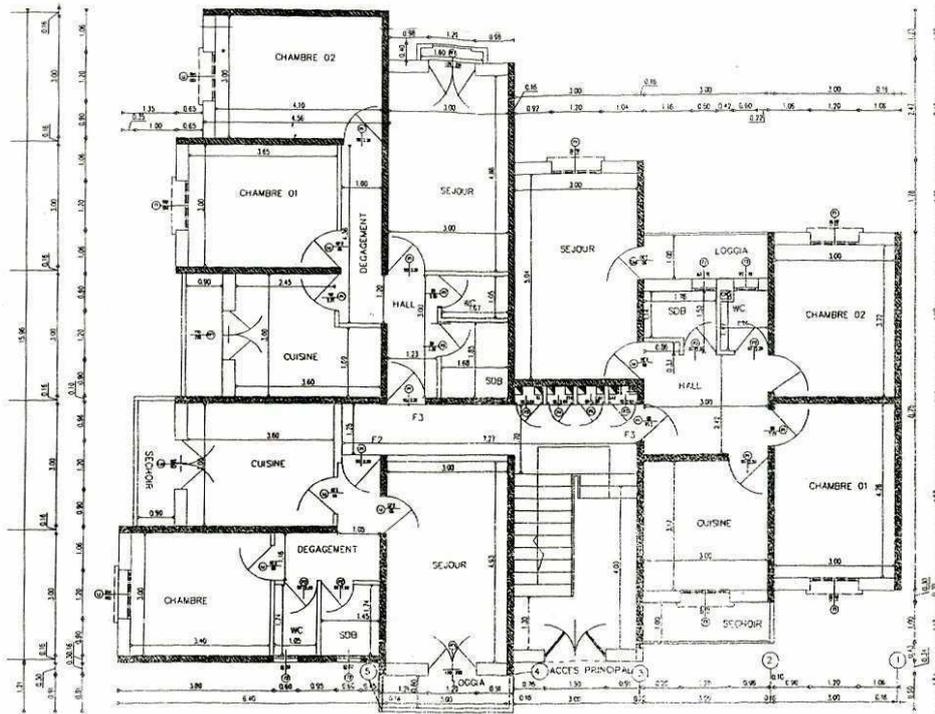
un exemple de structure en murs porteurs préfabriqués
